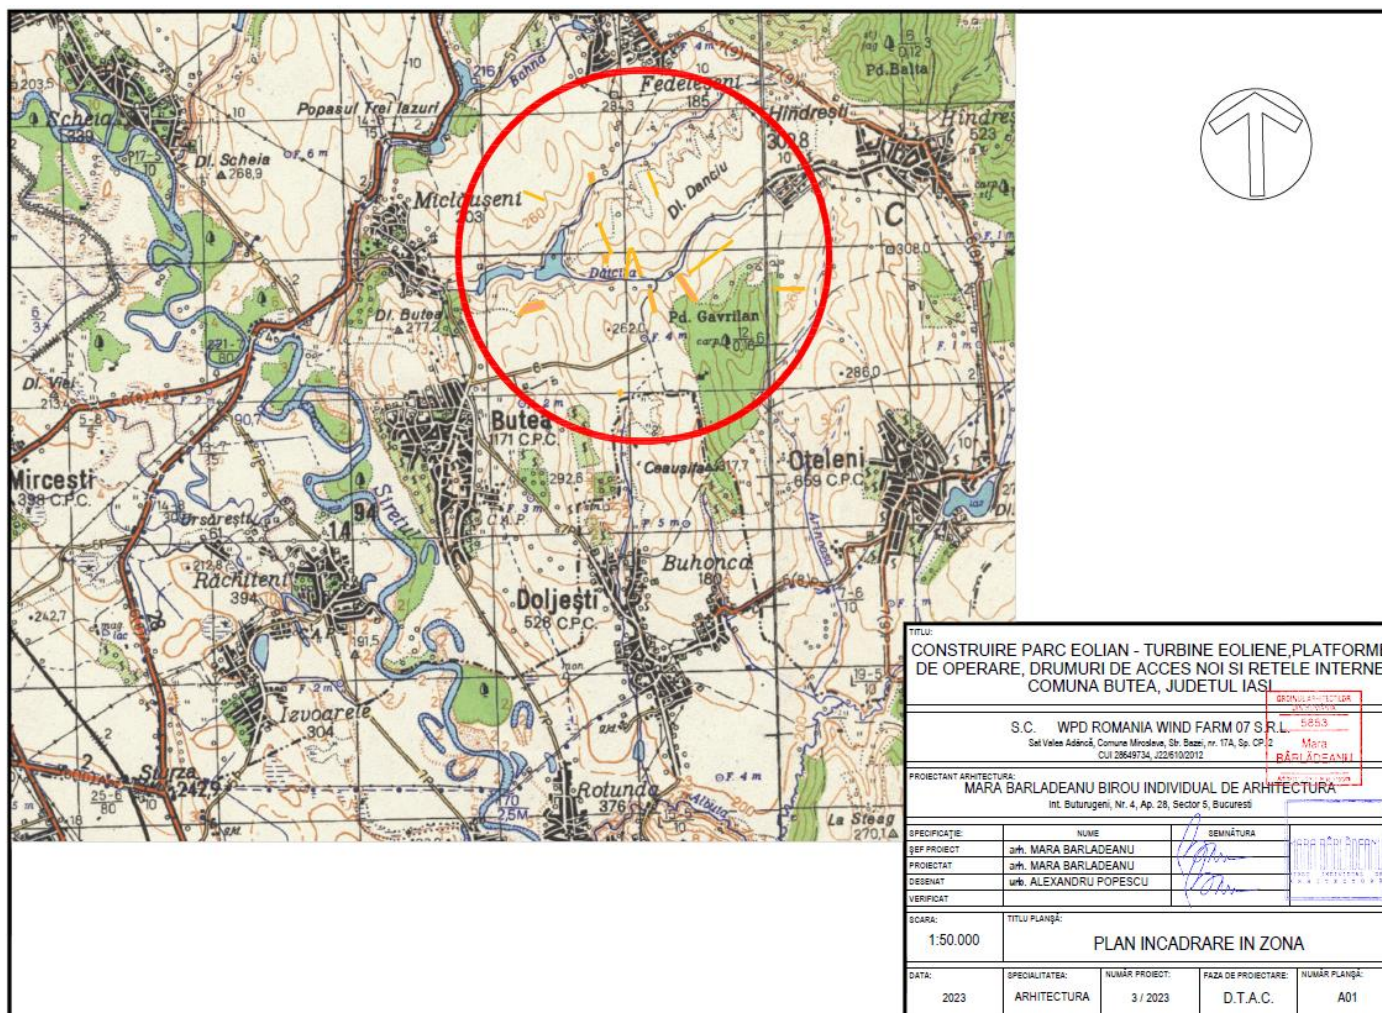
Plan de încadrare – Parc eolian BUTEA - încadrarea în zona
